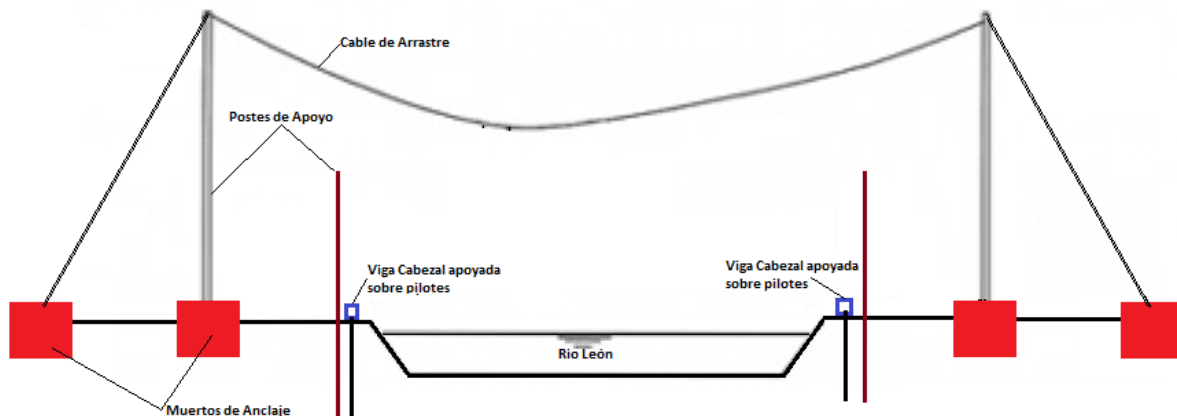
Alzado longitudinal estructura de apoyo y de arranque de arco
